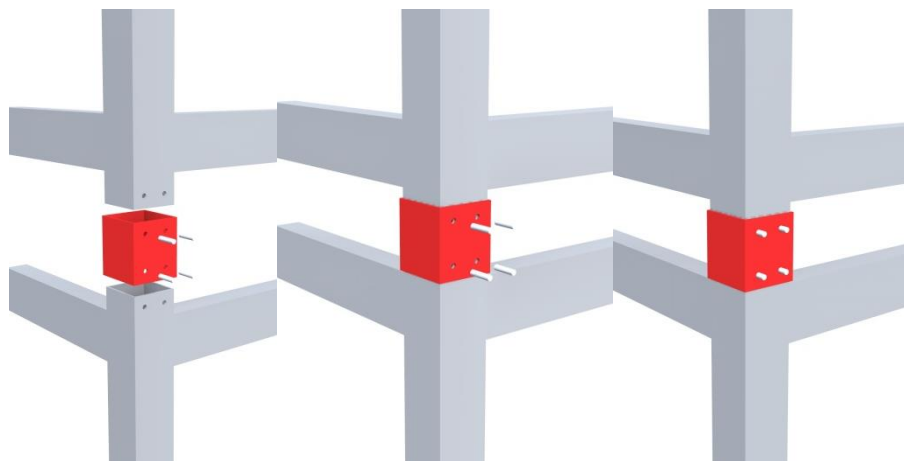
Detaliu de prindere pentru cele două module-țeavă pătrată + țevă rectangulară
